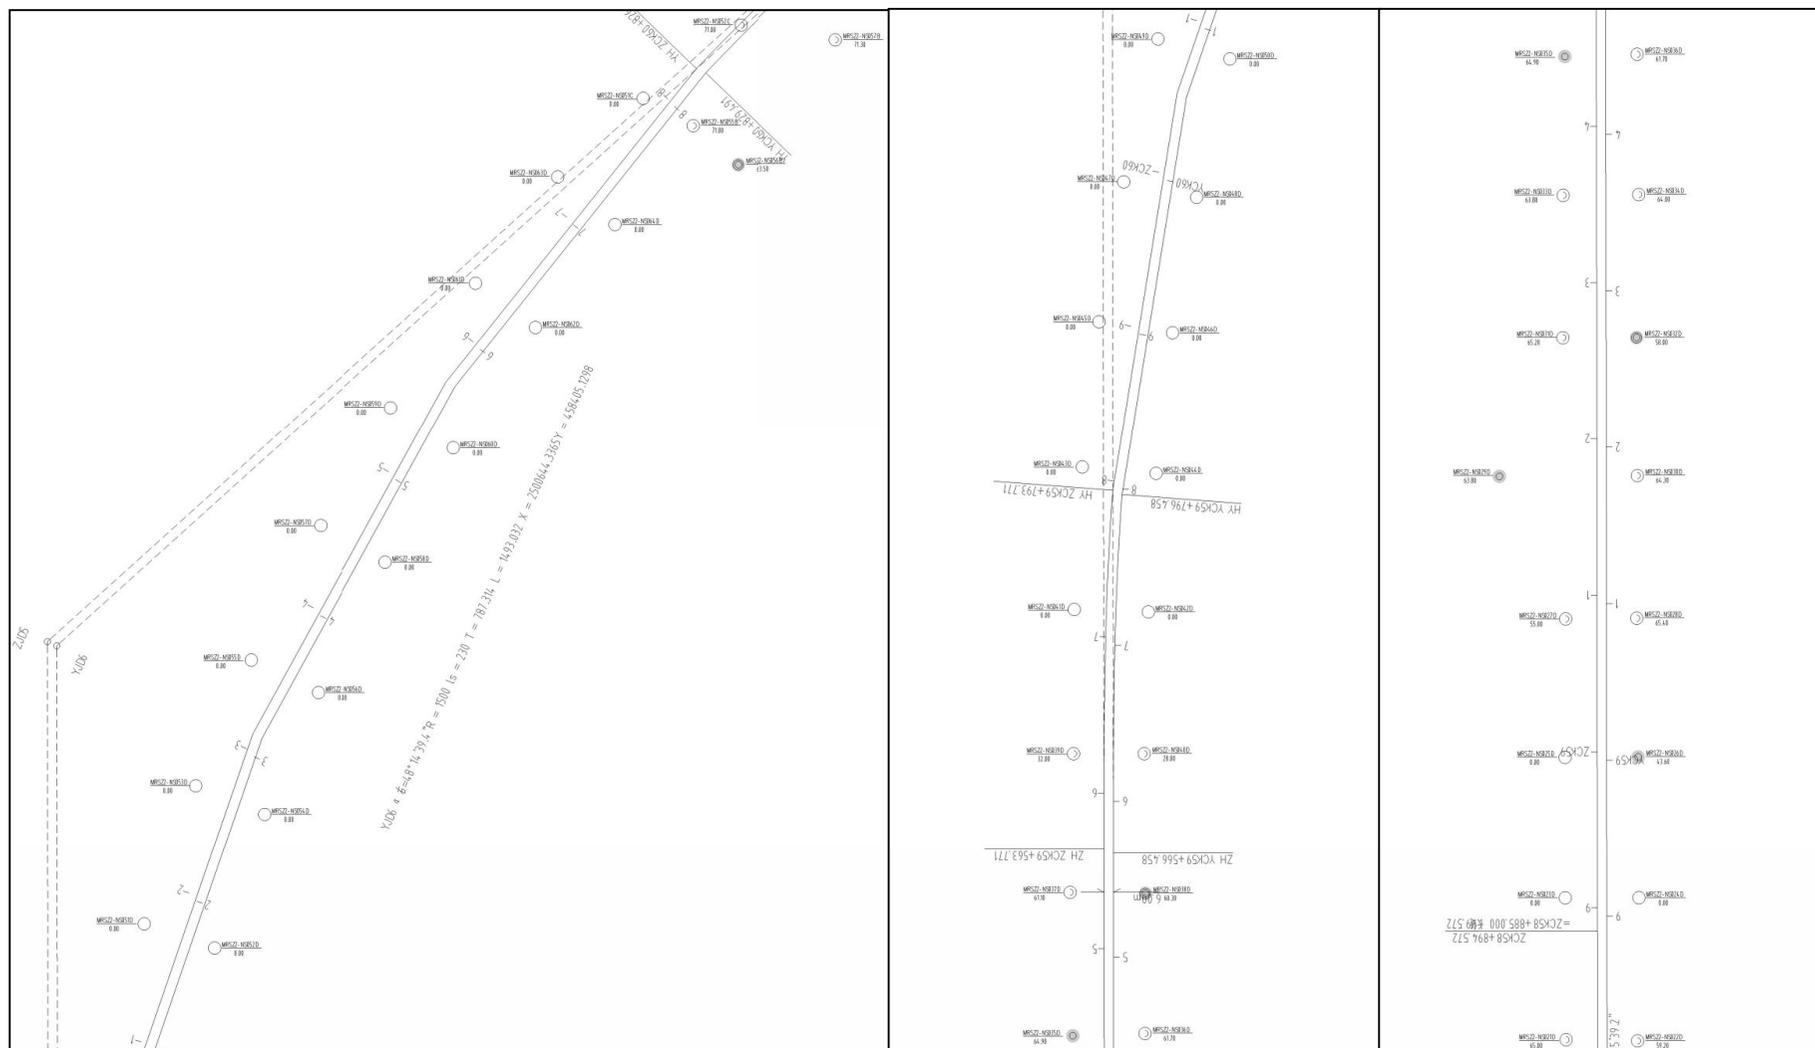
本项目工程地质勘察平面图（洪奇沥水道段）
